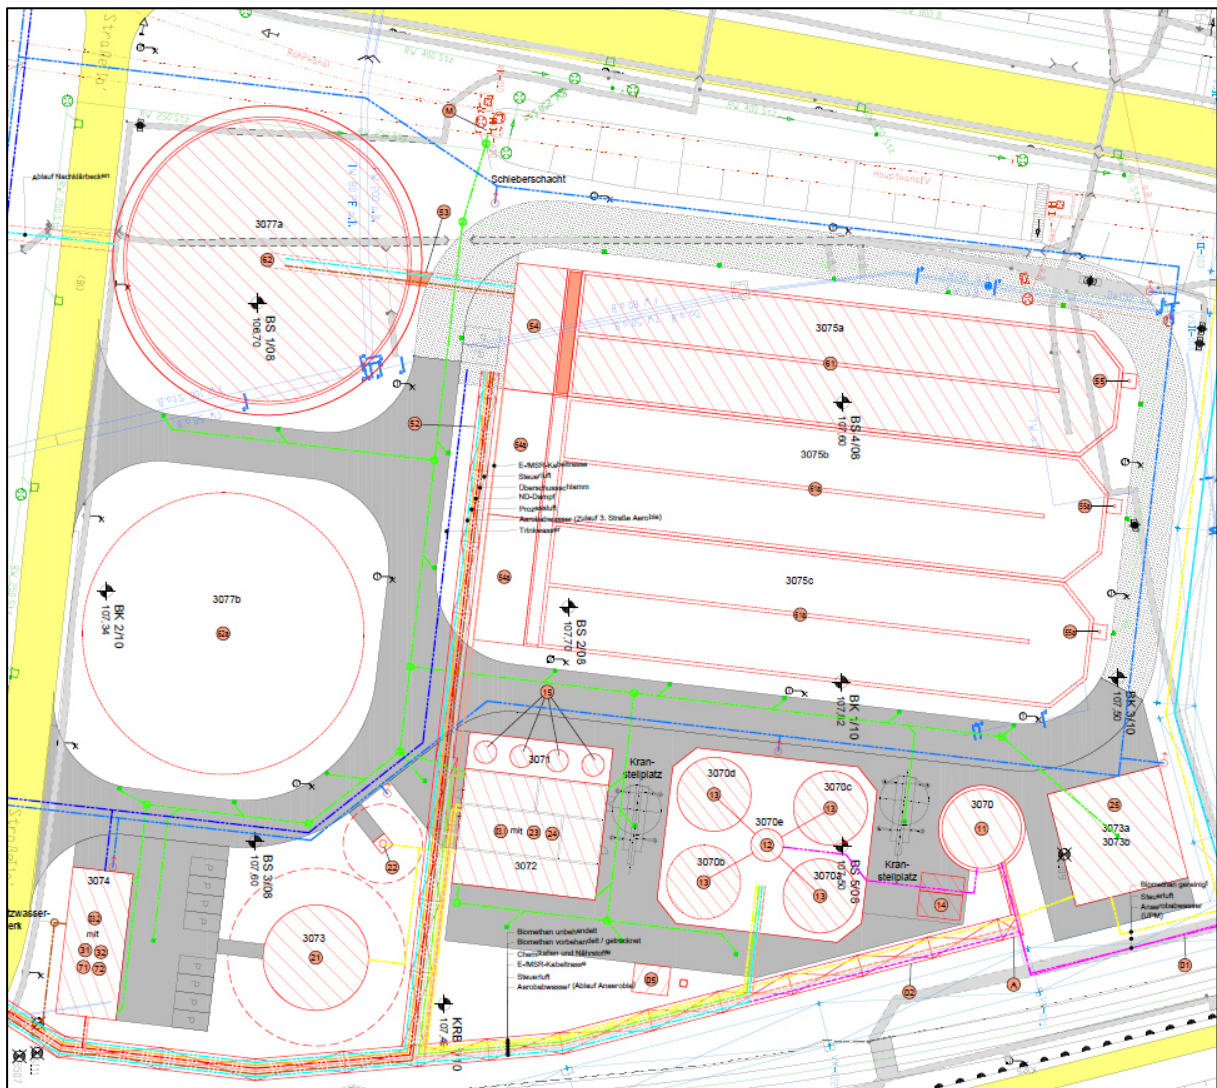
Auszug aus dem übergebenen Lageplan – Bereich NEF ZAB, unmaßstäblich, aus [U 6]
